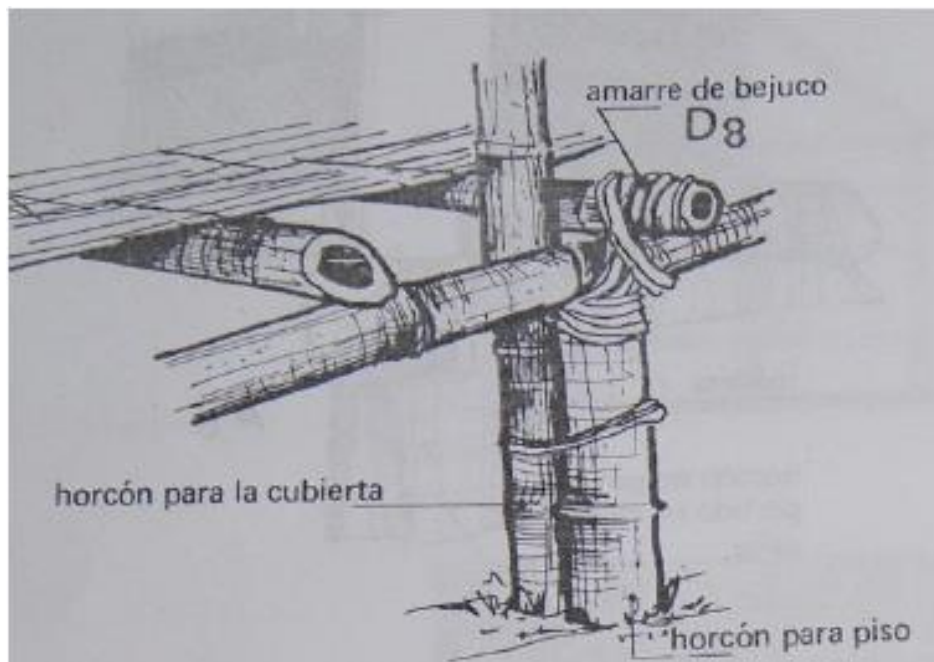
Armado estructural del piso de pambil para una vivienda.
